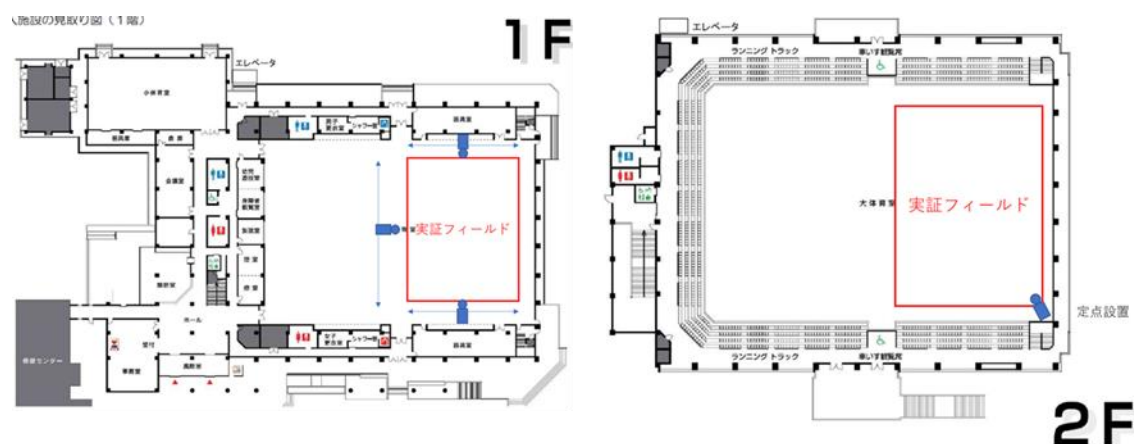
田川市総合体育館平面図および実証フィールドの構成例
